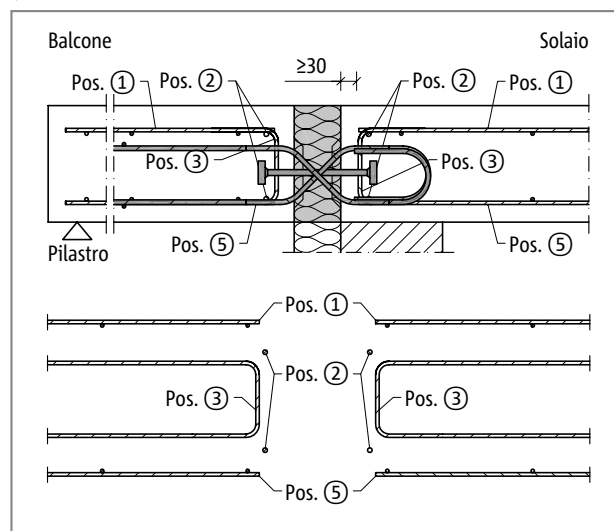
Schöck Isokorb® tipo QP-VV, armatura in opera
